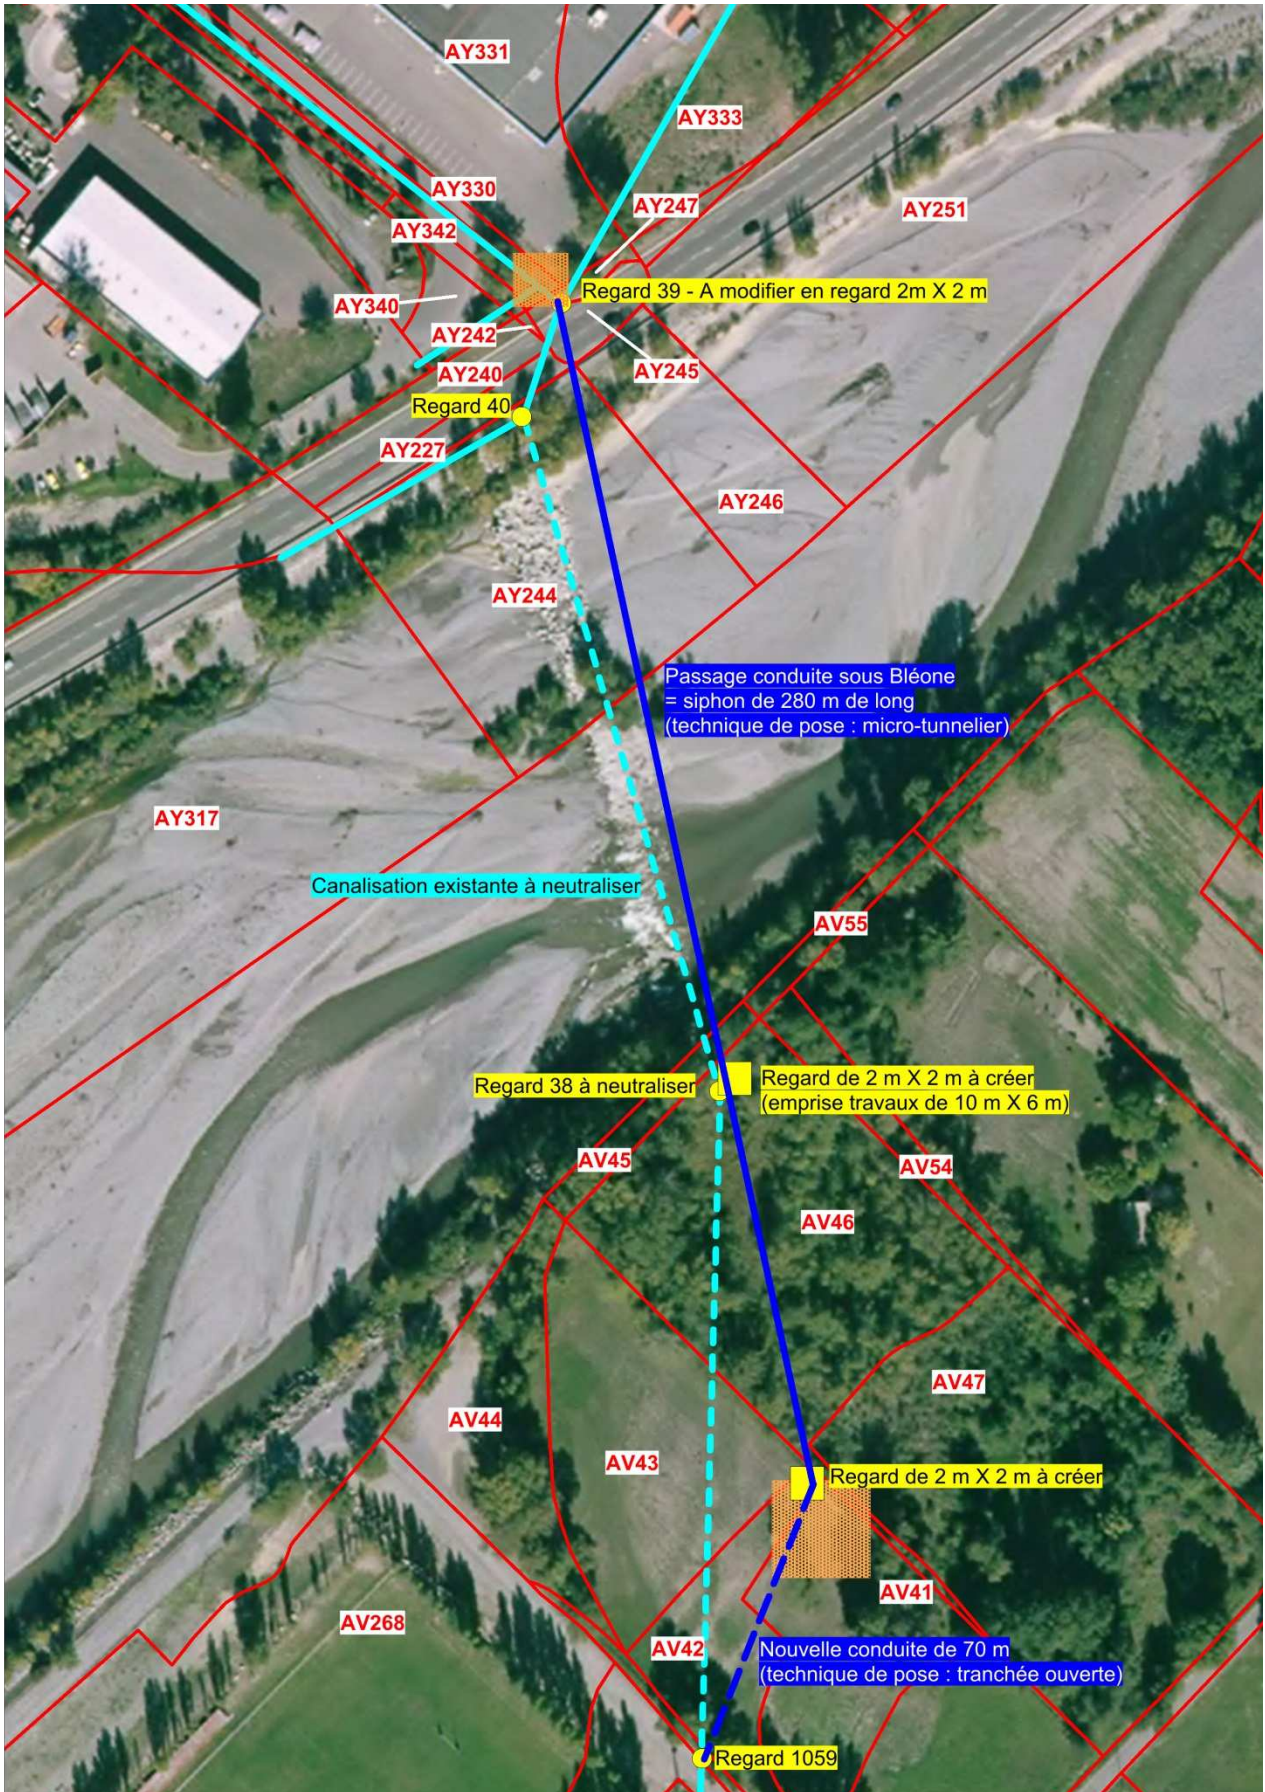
Arasement du seuil de la canalisation eaux usées – Extrait cadastral (zoom seuil et conduite d'eaux usées)
